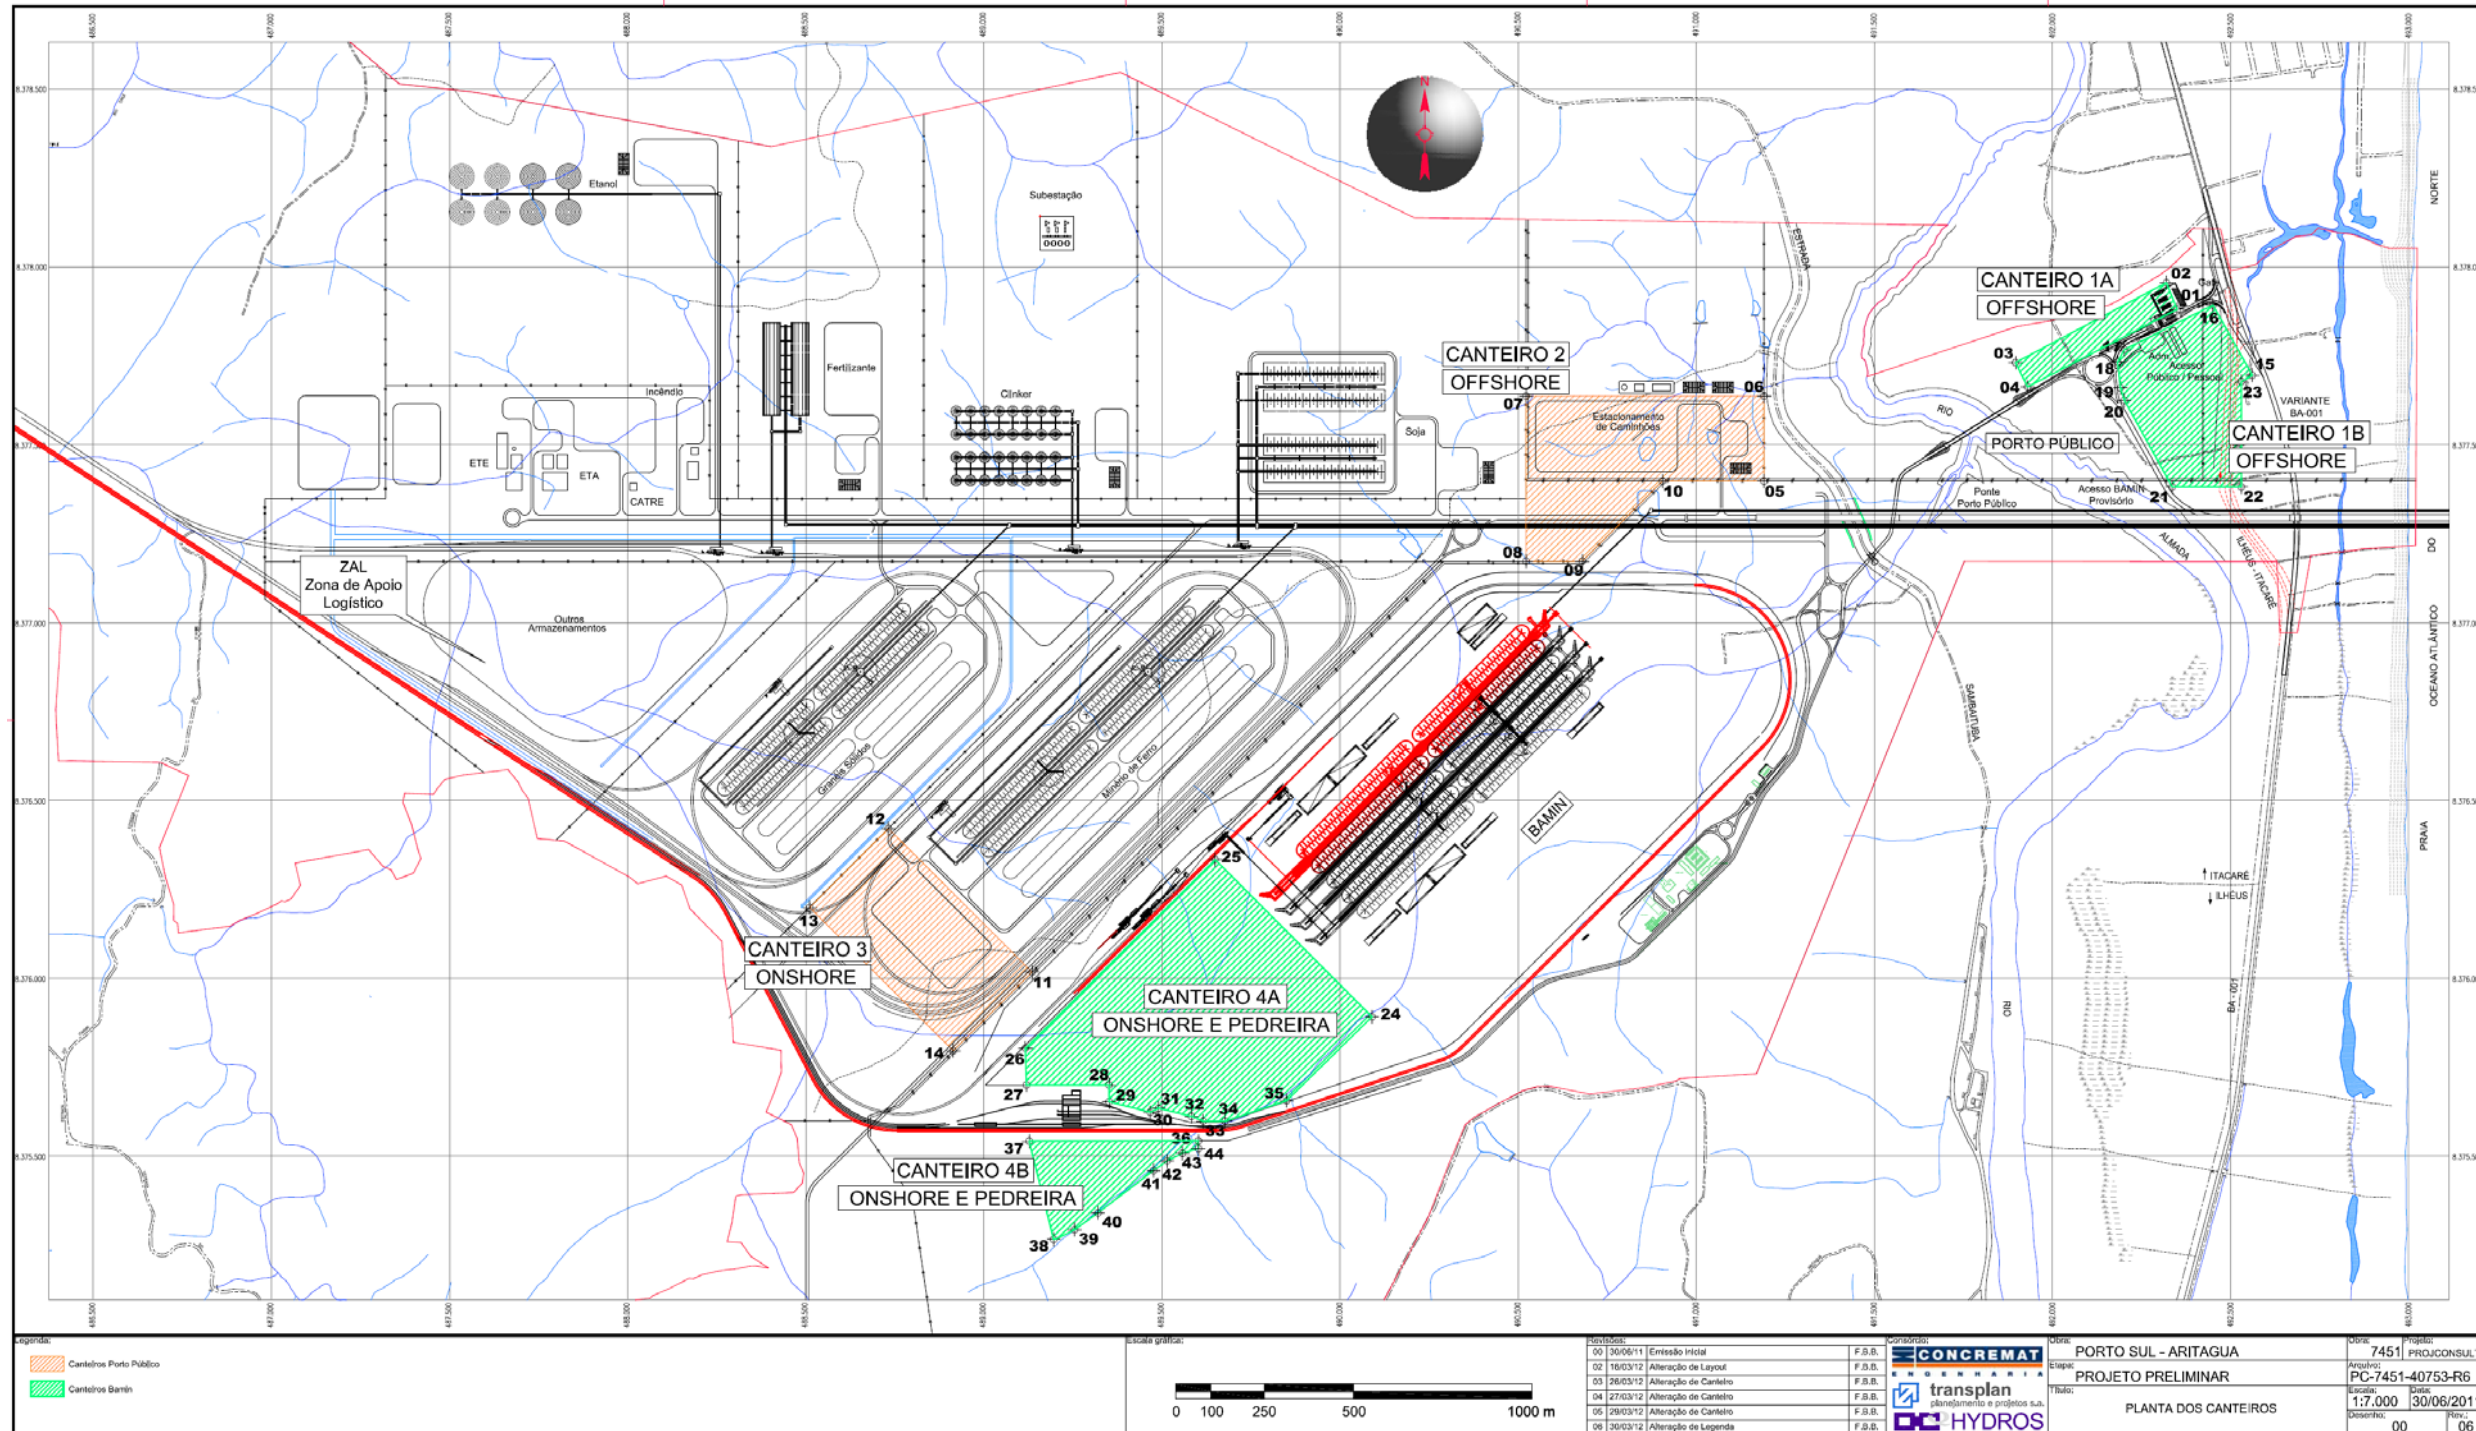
Layout Onshore do Porto Sul – Acesso de Ligação entre a Pedreira Aninga e o Canteiro Offshore do TUP BAMIN
